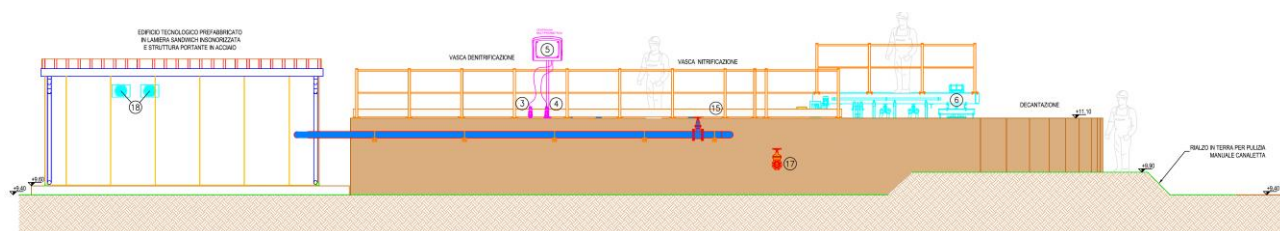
Prospetto nord-ovest del nuovo impianto di depurazione
